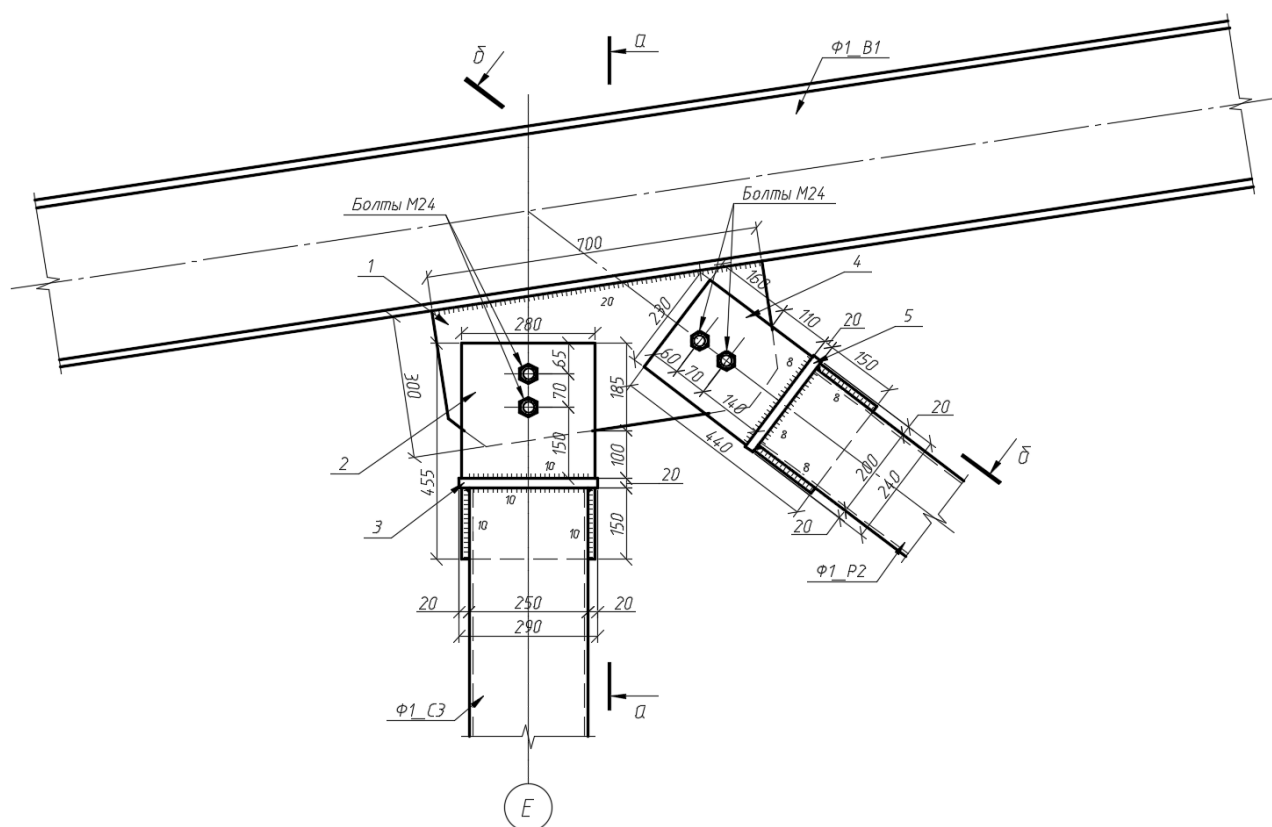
Узел крепления стойки и раскоса к верхнему поясу
